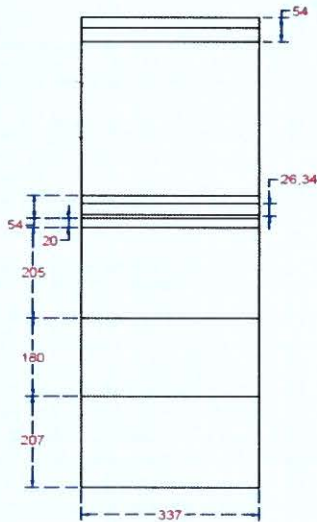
Esquema de Construcción - corte Transversal- Panel Tipo A.
